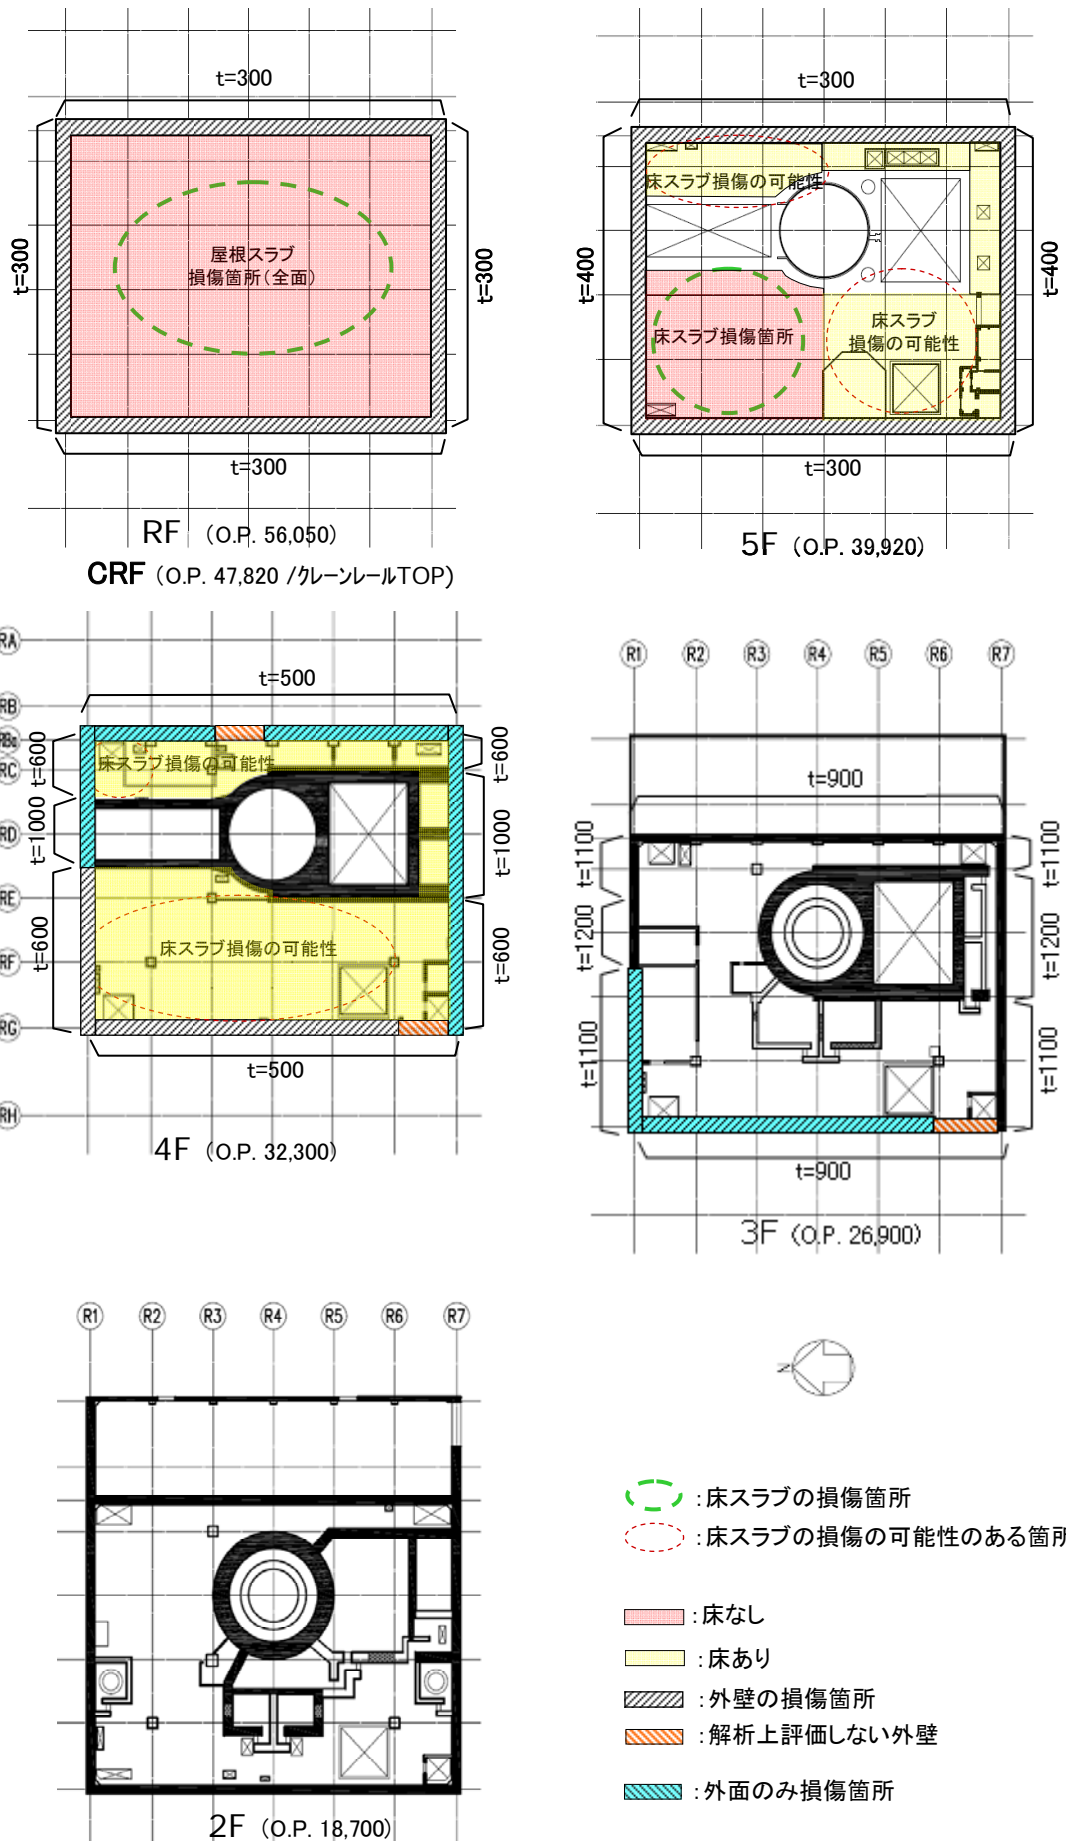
3号機原子炉建屋の損傷状況（平面図）
